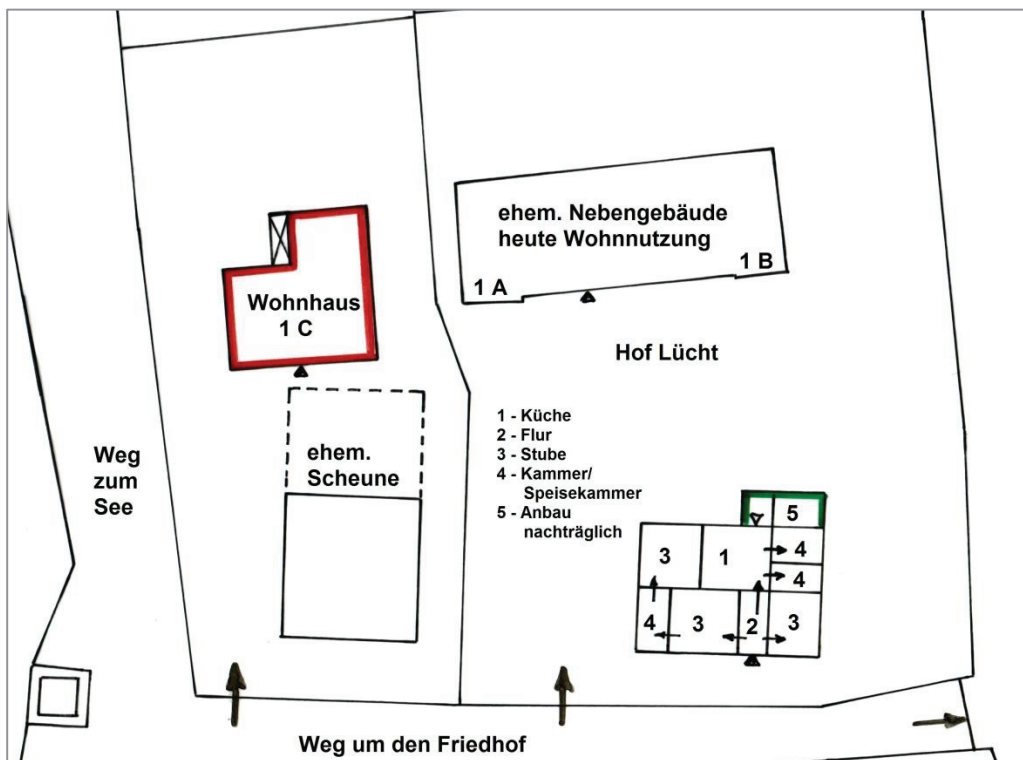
Skizze ehemaliger Hof Lücht mit Grundriss des früheren Wohnhauses
